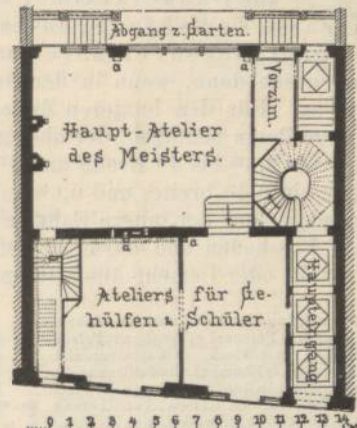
Ateliers des Bildhauers V. Vilain zu Paris (Architekt J. Uchard).
